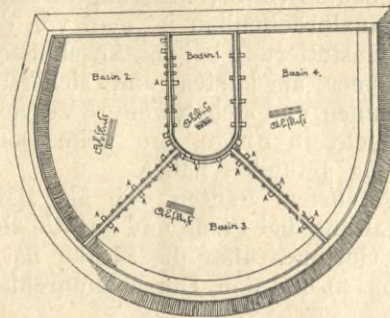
Grundriss des Klärbassins in Kansas City (Mo.).
